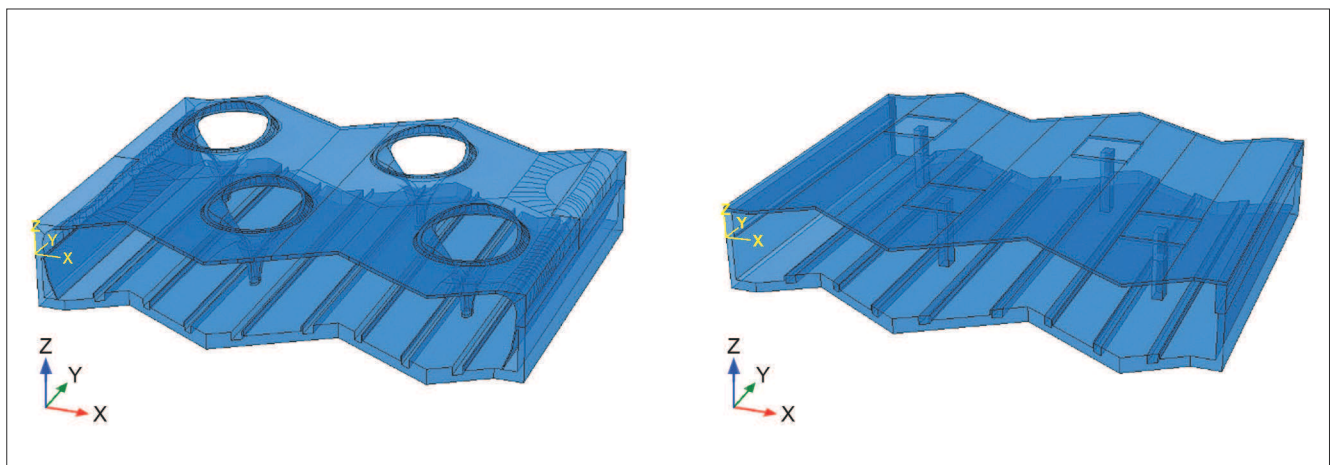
Detaillierter Ausschnitt aus der Bahnhofshalle (links) und geometrisch vereinfachtes Modell (rechts)
